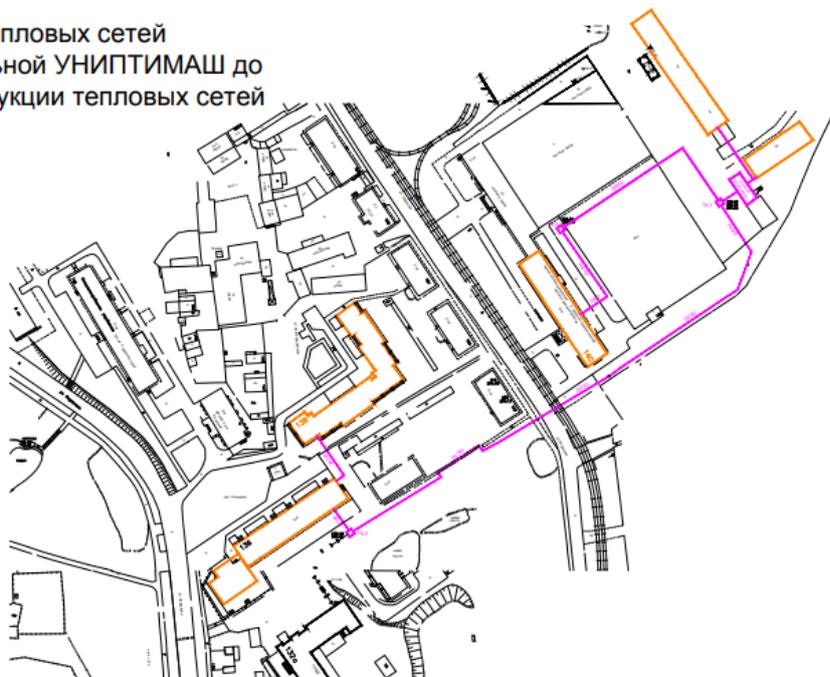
Схема тепловых сетей от котельной УНИПТИМАШ до реконструкции
